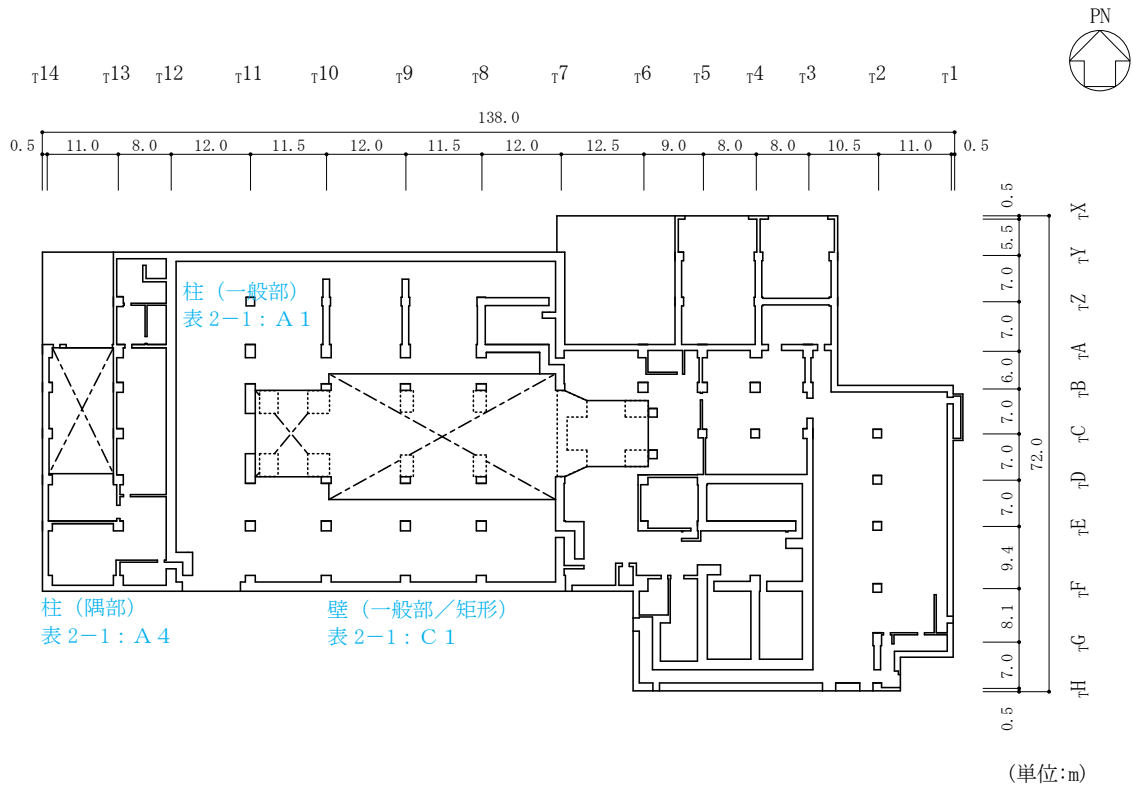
(3) タービン建物の概略平面図 (EL 12.5m)
